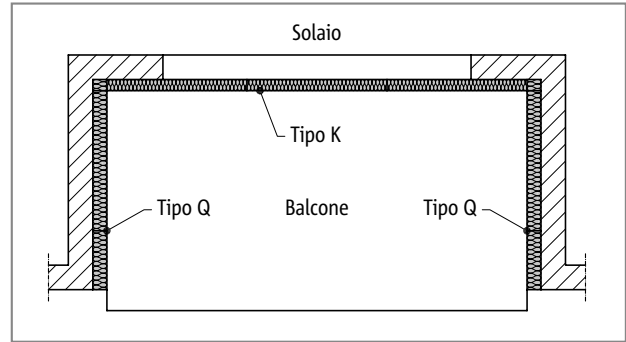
Schöck Isokorb® tipo K e tipo Q, balcone con tre appoggi
